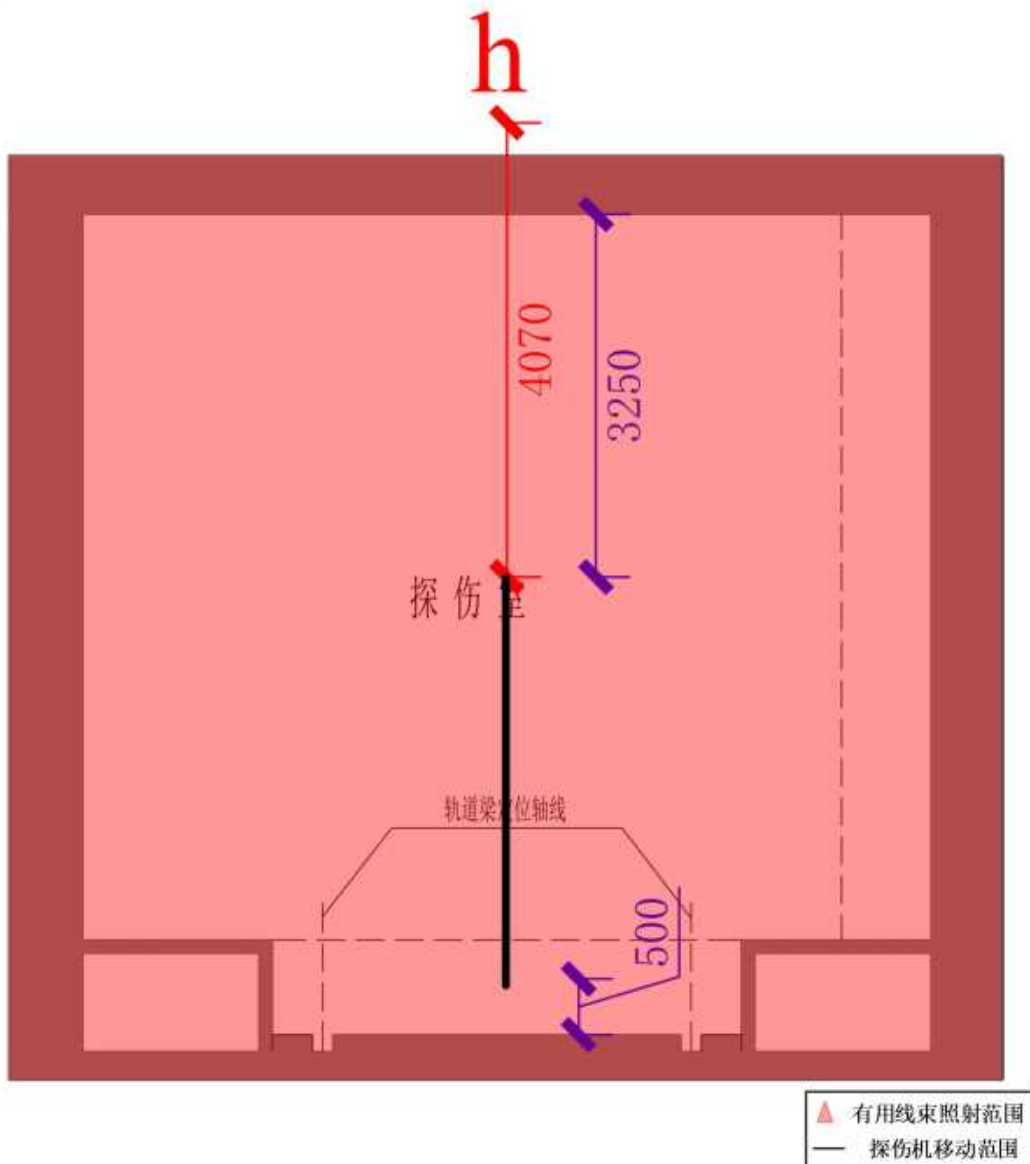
探伤室关注点位示意图（东西方向剖面图，单位：mm）
